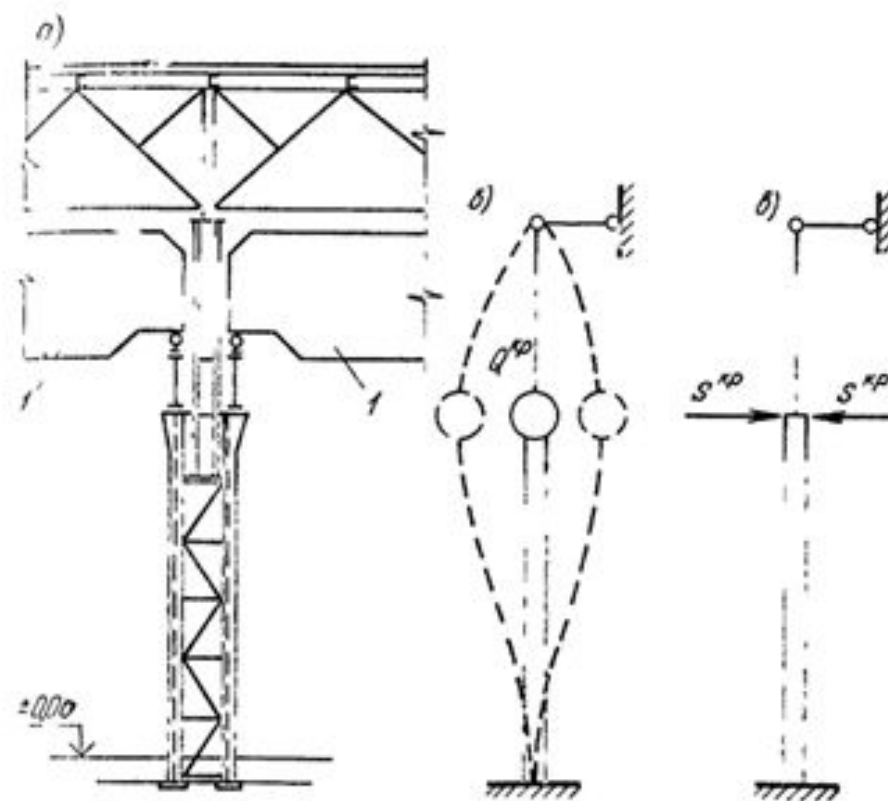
Схемы к расчету колонны на местную сейсмическую нагрузку от собственного веса моста крана
